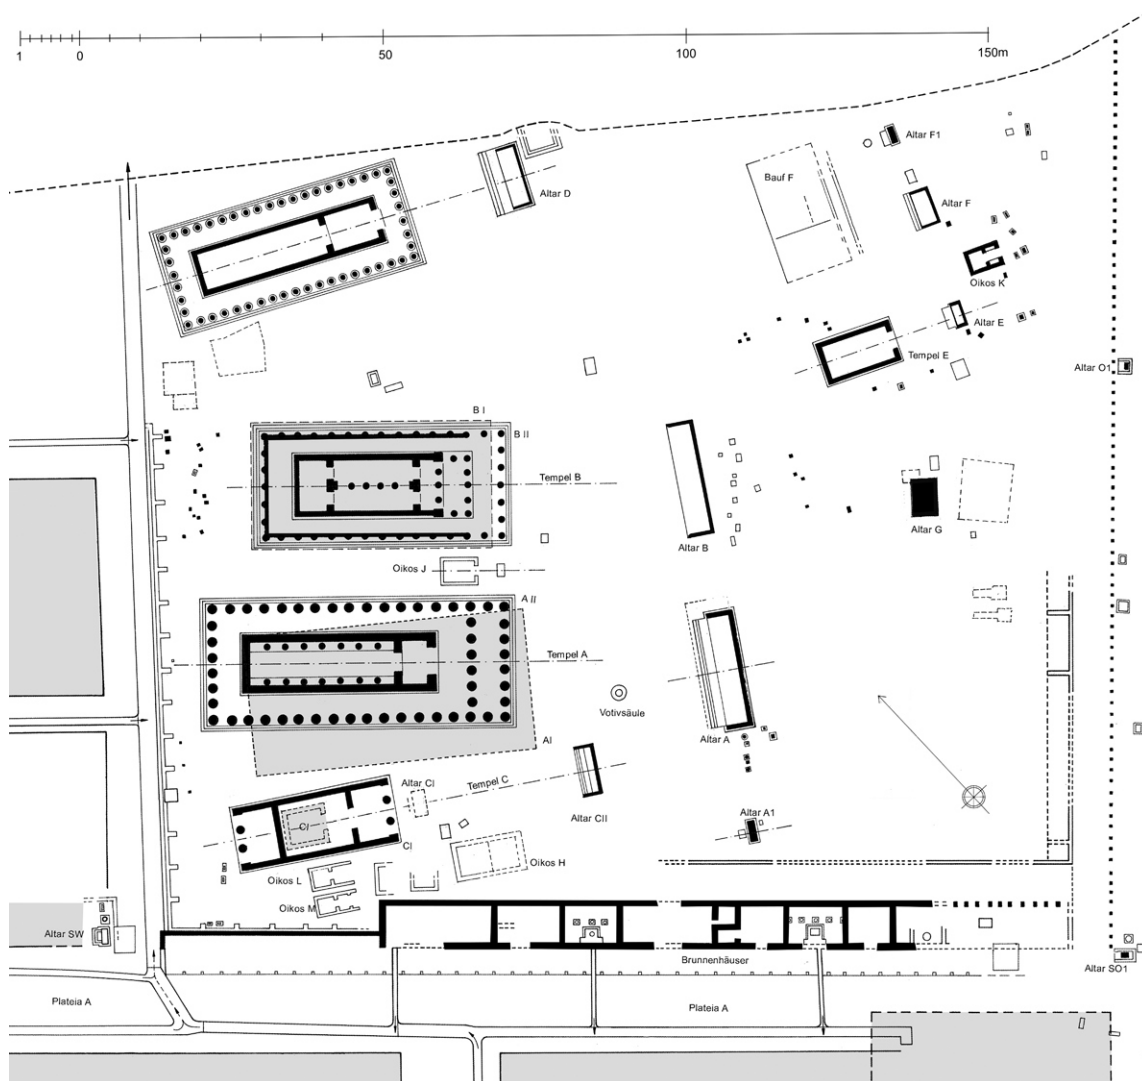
Lage des Tempels im Stadtheiligtum, Rekonstruktionsplan (M. 1 : 1250)
